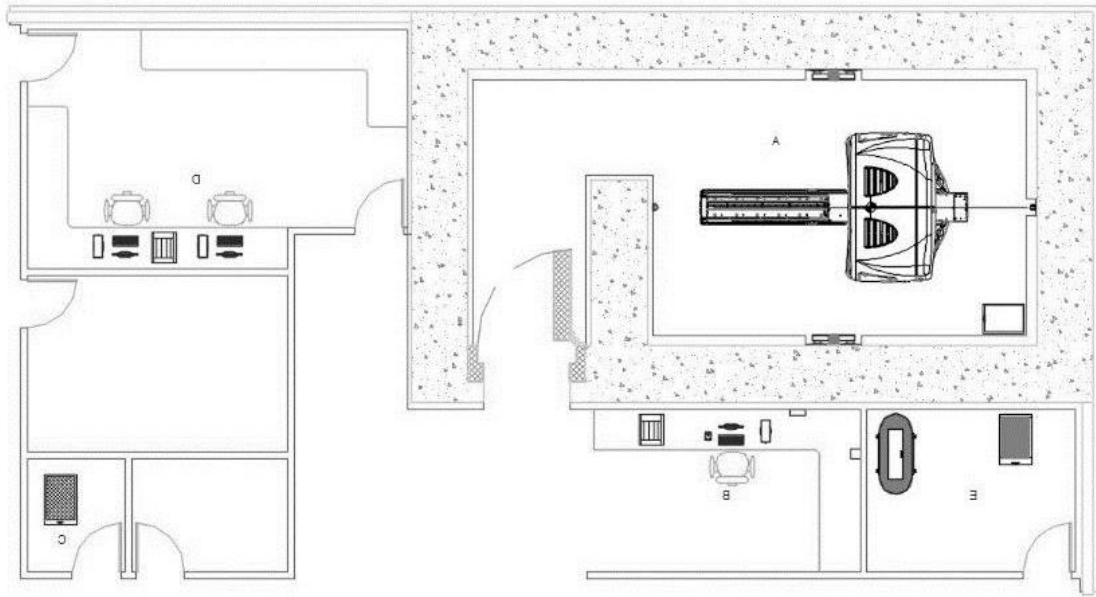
Plano de planta típico del sistema Radixact con laberinto [16].
